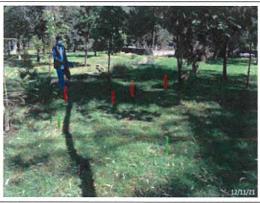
Columna 24 dentro de SEDENA, en rojo se observa la proyección de los ejes de la calzada y en verde las cimentaciones.
